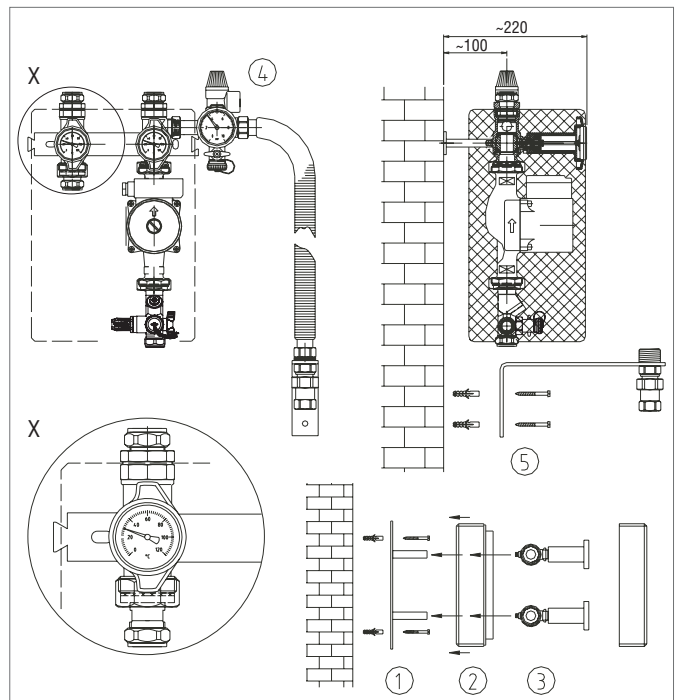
Монтаж насосного узла REHAU SOLECT
